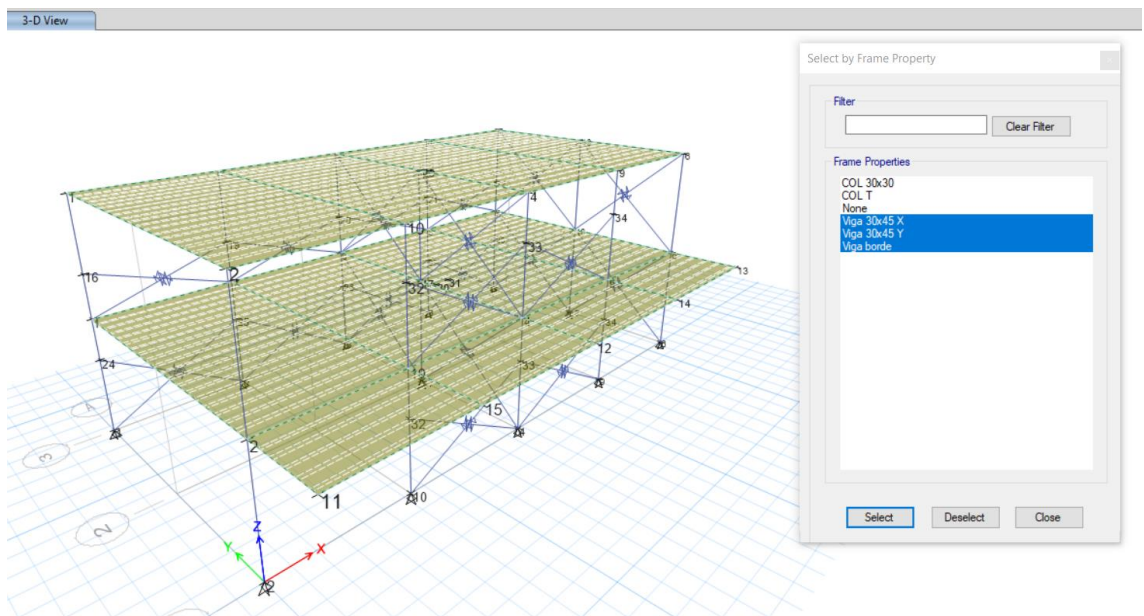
Elección de Hinges para las asignar las rotulas plásticas en vigas 101A
